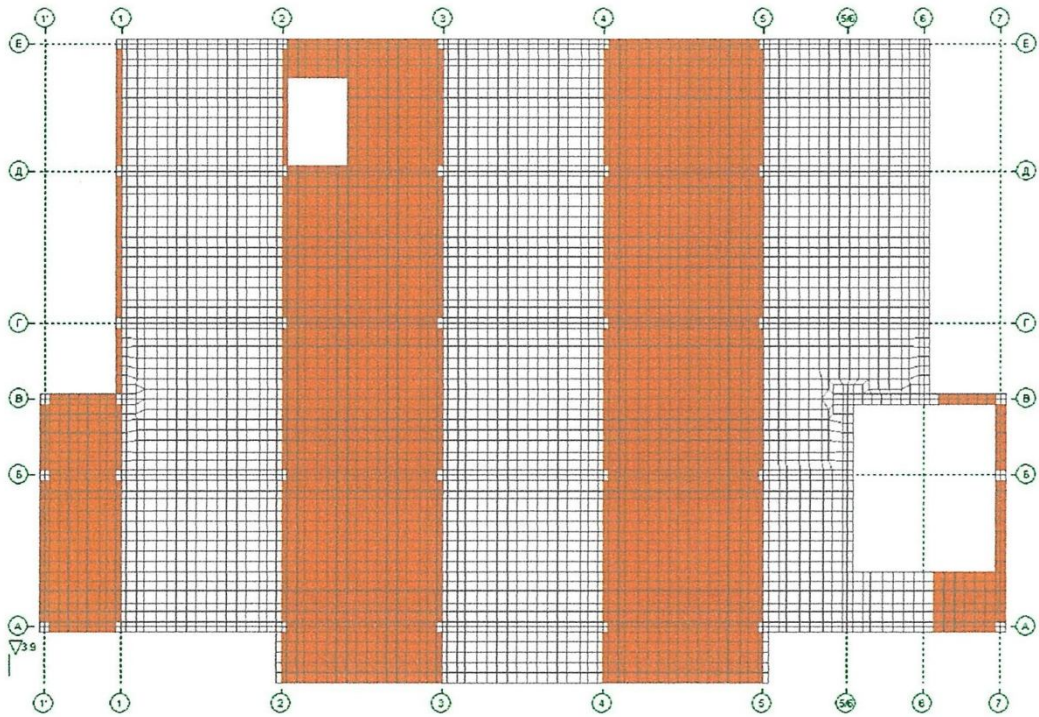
Схема завантаження 3 – Тимчасове навантаження на плити на відм.3.9, т/м<sup>2</sup>
